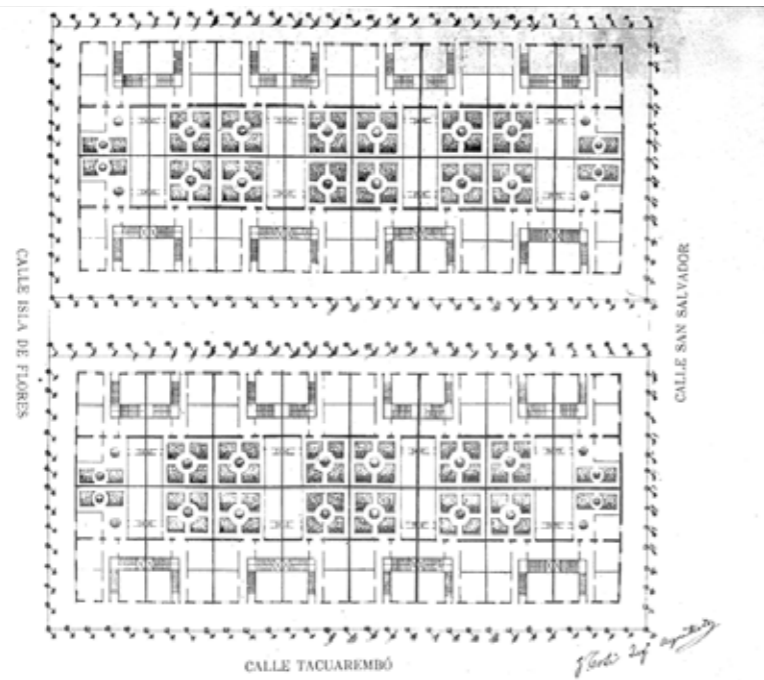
Planta general. Fuente: IHA, Montevideo
